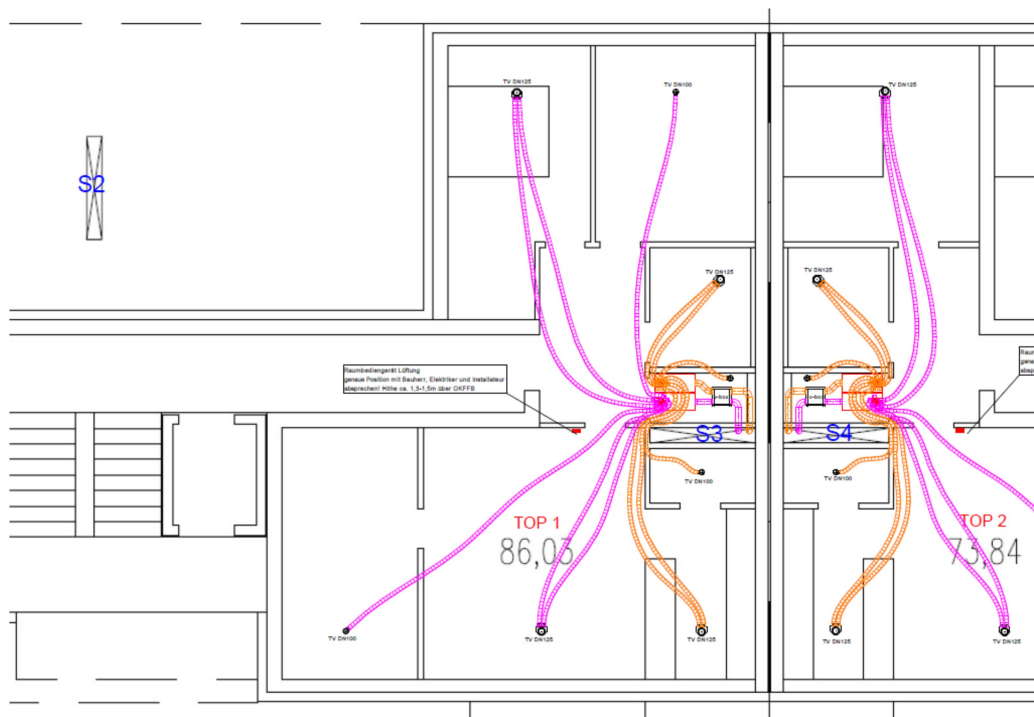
Grundriss Wohnung EG, System B (Eigene Darstellung, Filip Andic, 2015)
